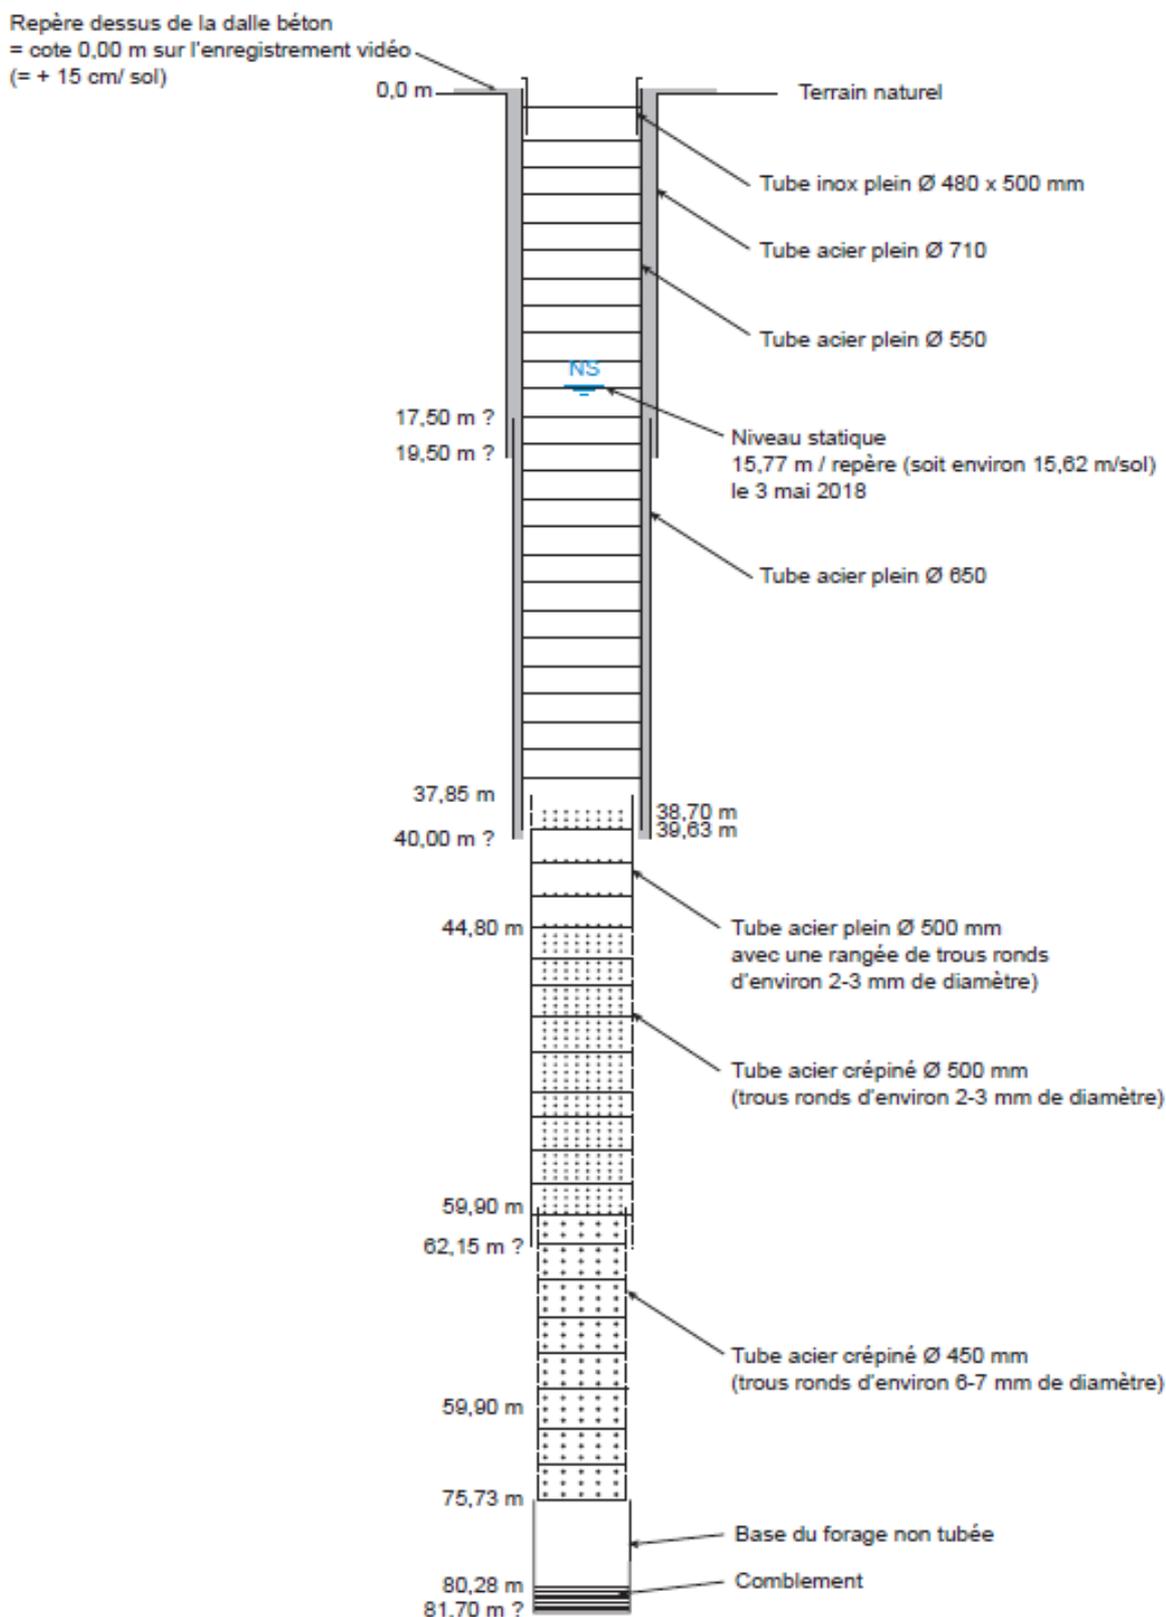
Coupe issue du rapport d'inspection finale (source : EDREE – Mai 2018)
